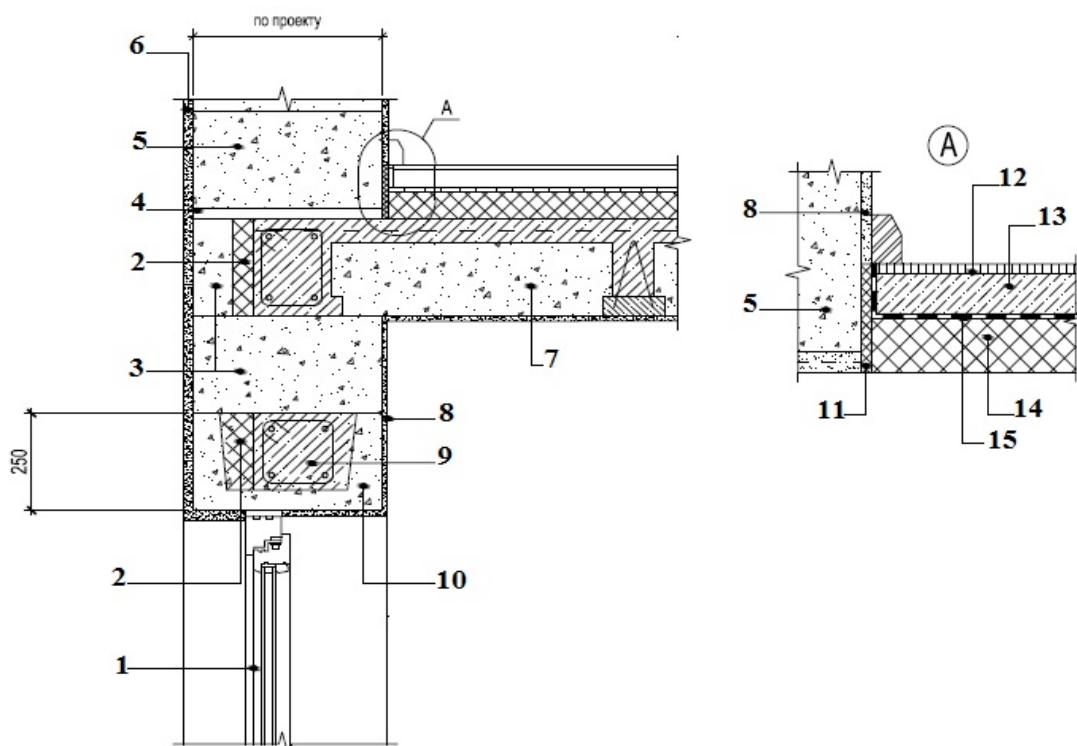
Узел опирания перекрытия на стену из газобетонных блоков в районе оконного проема: 1 — оконный блок; 2 — минеральная вата; 3 — доборный блок; 4 — шов из цементного раствора армированный; 5 — блоки YTONG; 6 — наружная стена; 7 — сборно-монолитное перекрытие YTONG; 8 — внутренняя отделка; 9 — монолитный железобетонный пояс; 10 — U-образный блок; 11 — пенополистирол; 12 — покрытие пола; 13 — цементная стяжка; 14 — утеплитель; 15 — гидроизоляция
